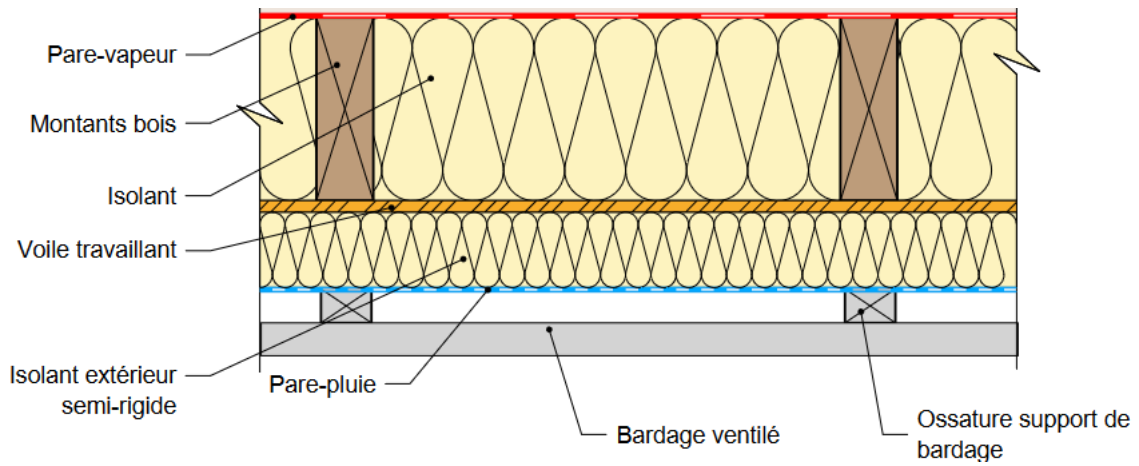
Paroi à ossature bois avec isolation entre montants et complément d'isolation par l'extérieur avec système pare-pluie ou de protection à l'eau souple sur support continu (coupe horizontale)
